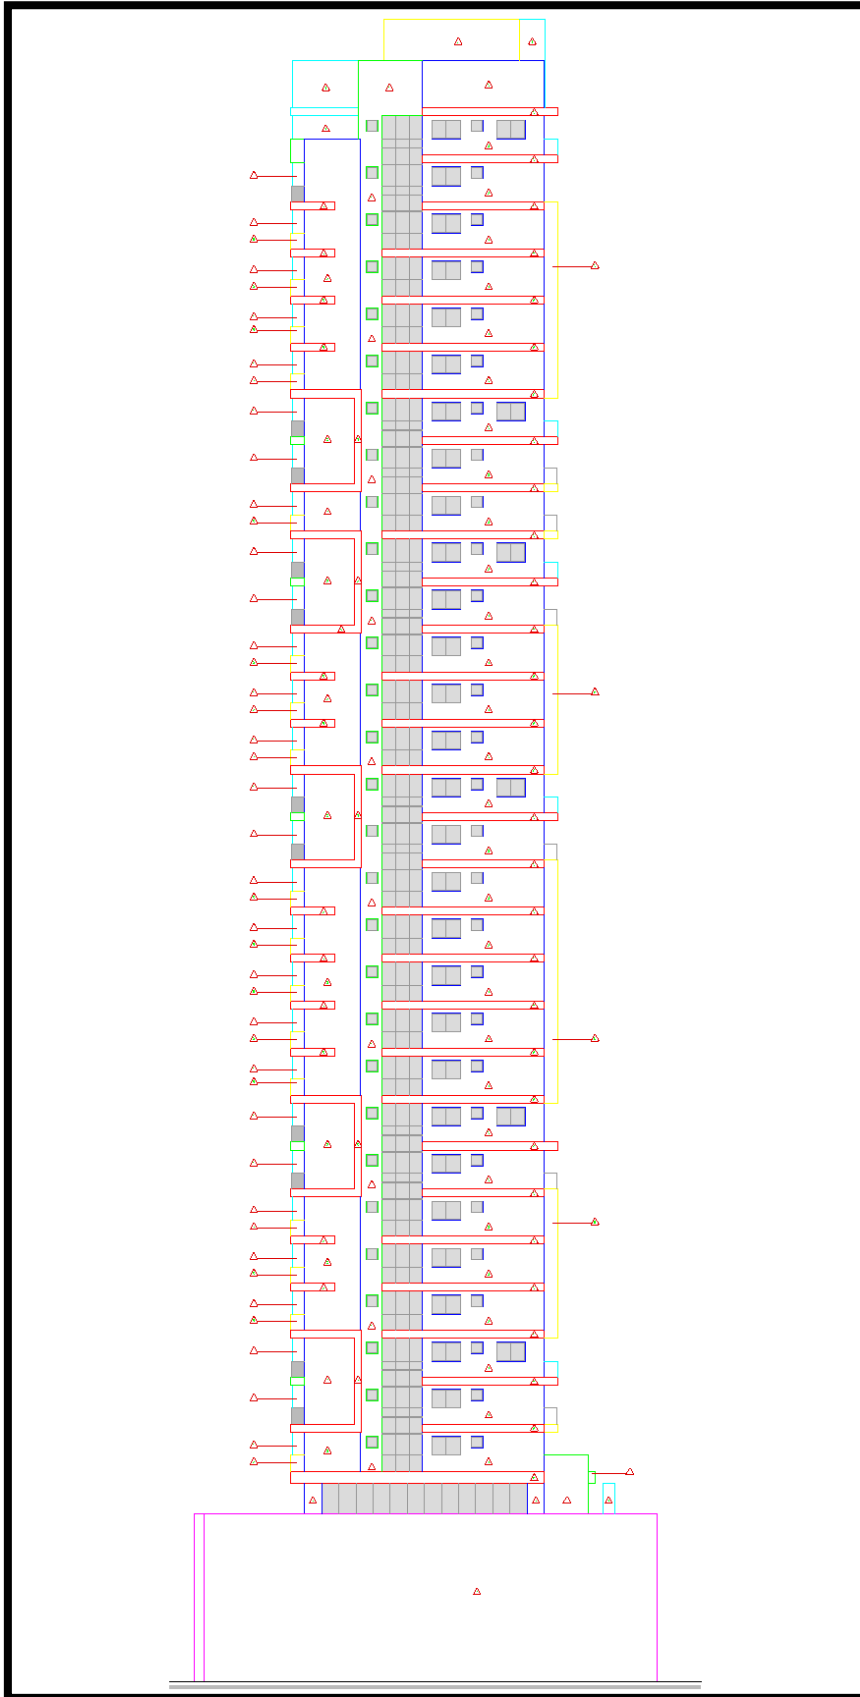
Planta Baixa Projeto Arquitetônico – Elevação Lateral Esquerda
